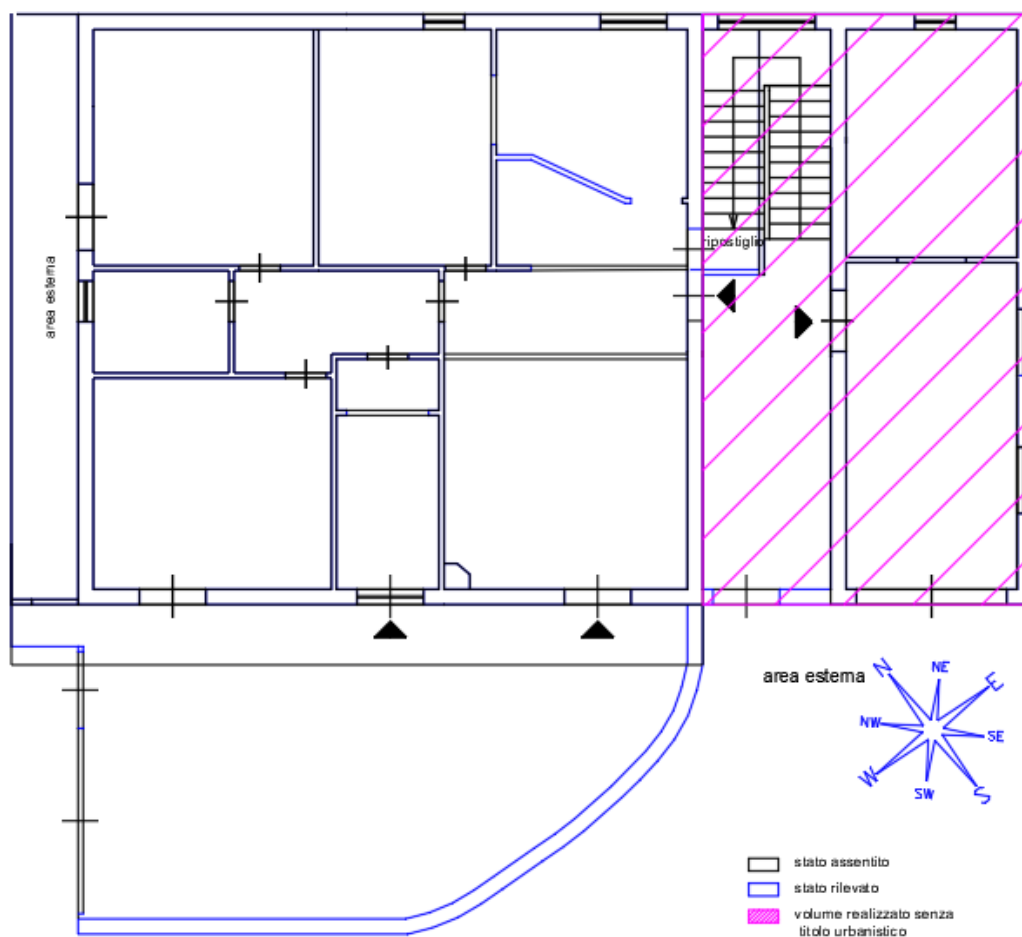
LOTTO 1 sovrapposizione planimetria stato rilevato su stato assentito, indicazione volumetria in eccesso – piano terra
